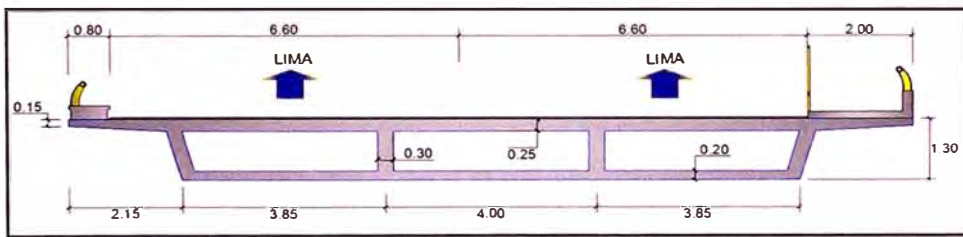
Sección transversal de la viga cajón, de VMT-VS a LIMA.
